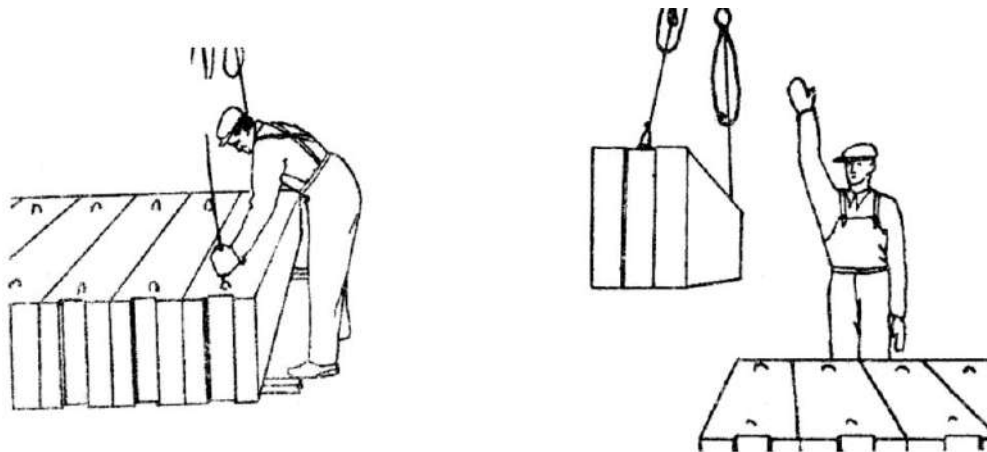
Строповка и подъем стенового фундаментного блока
